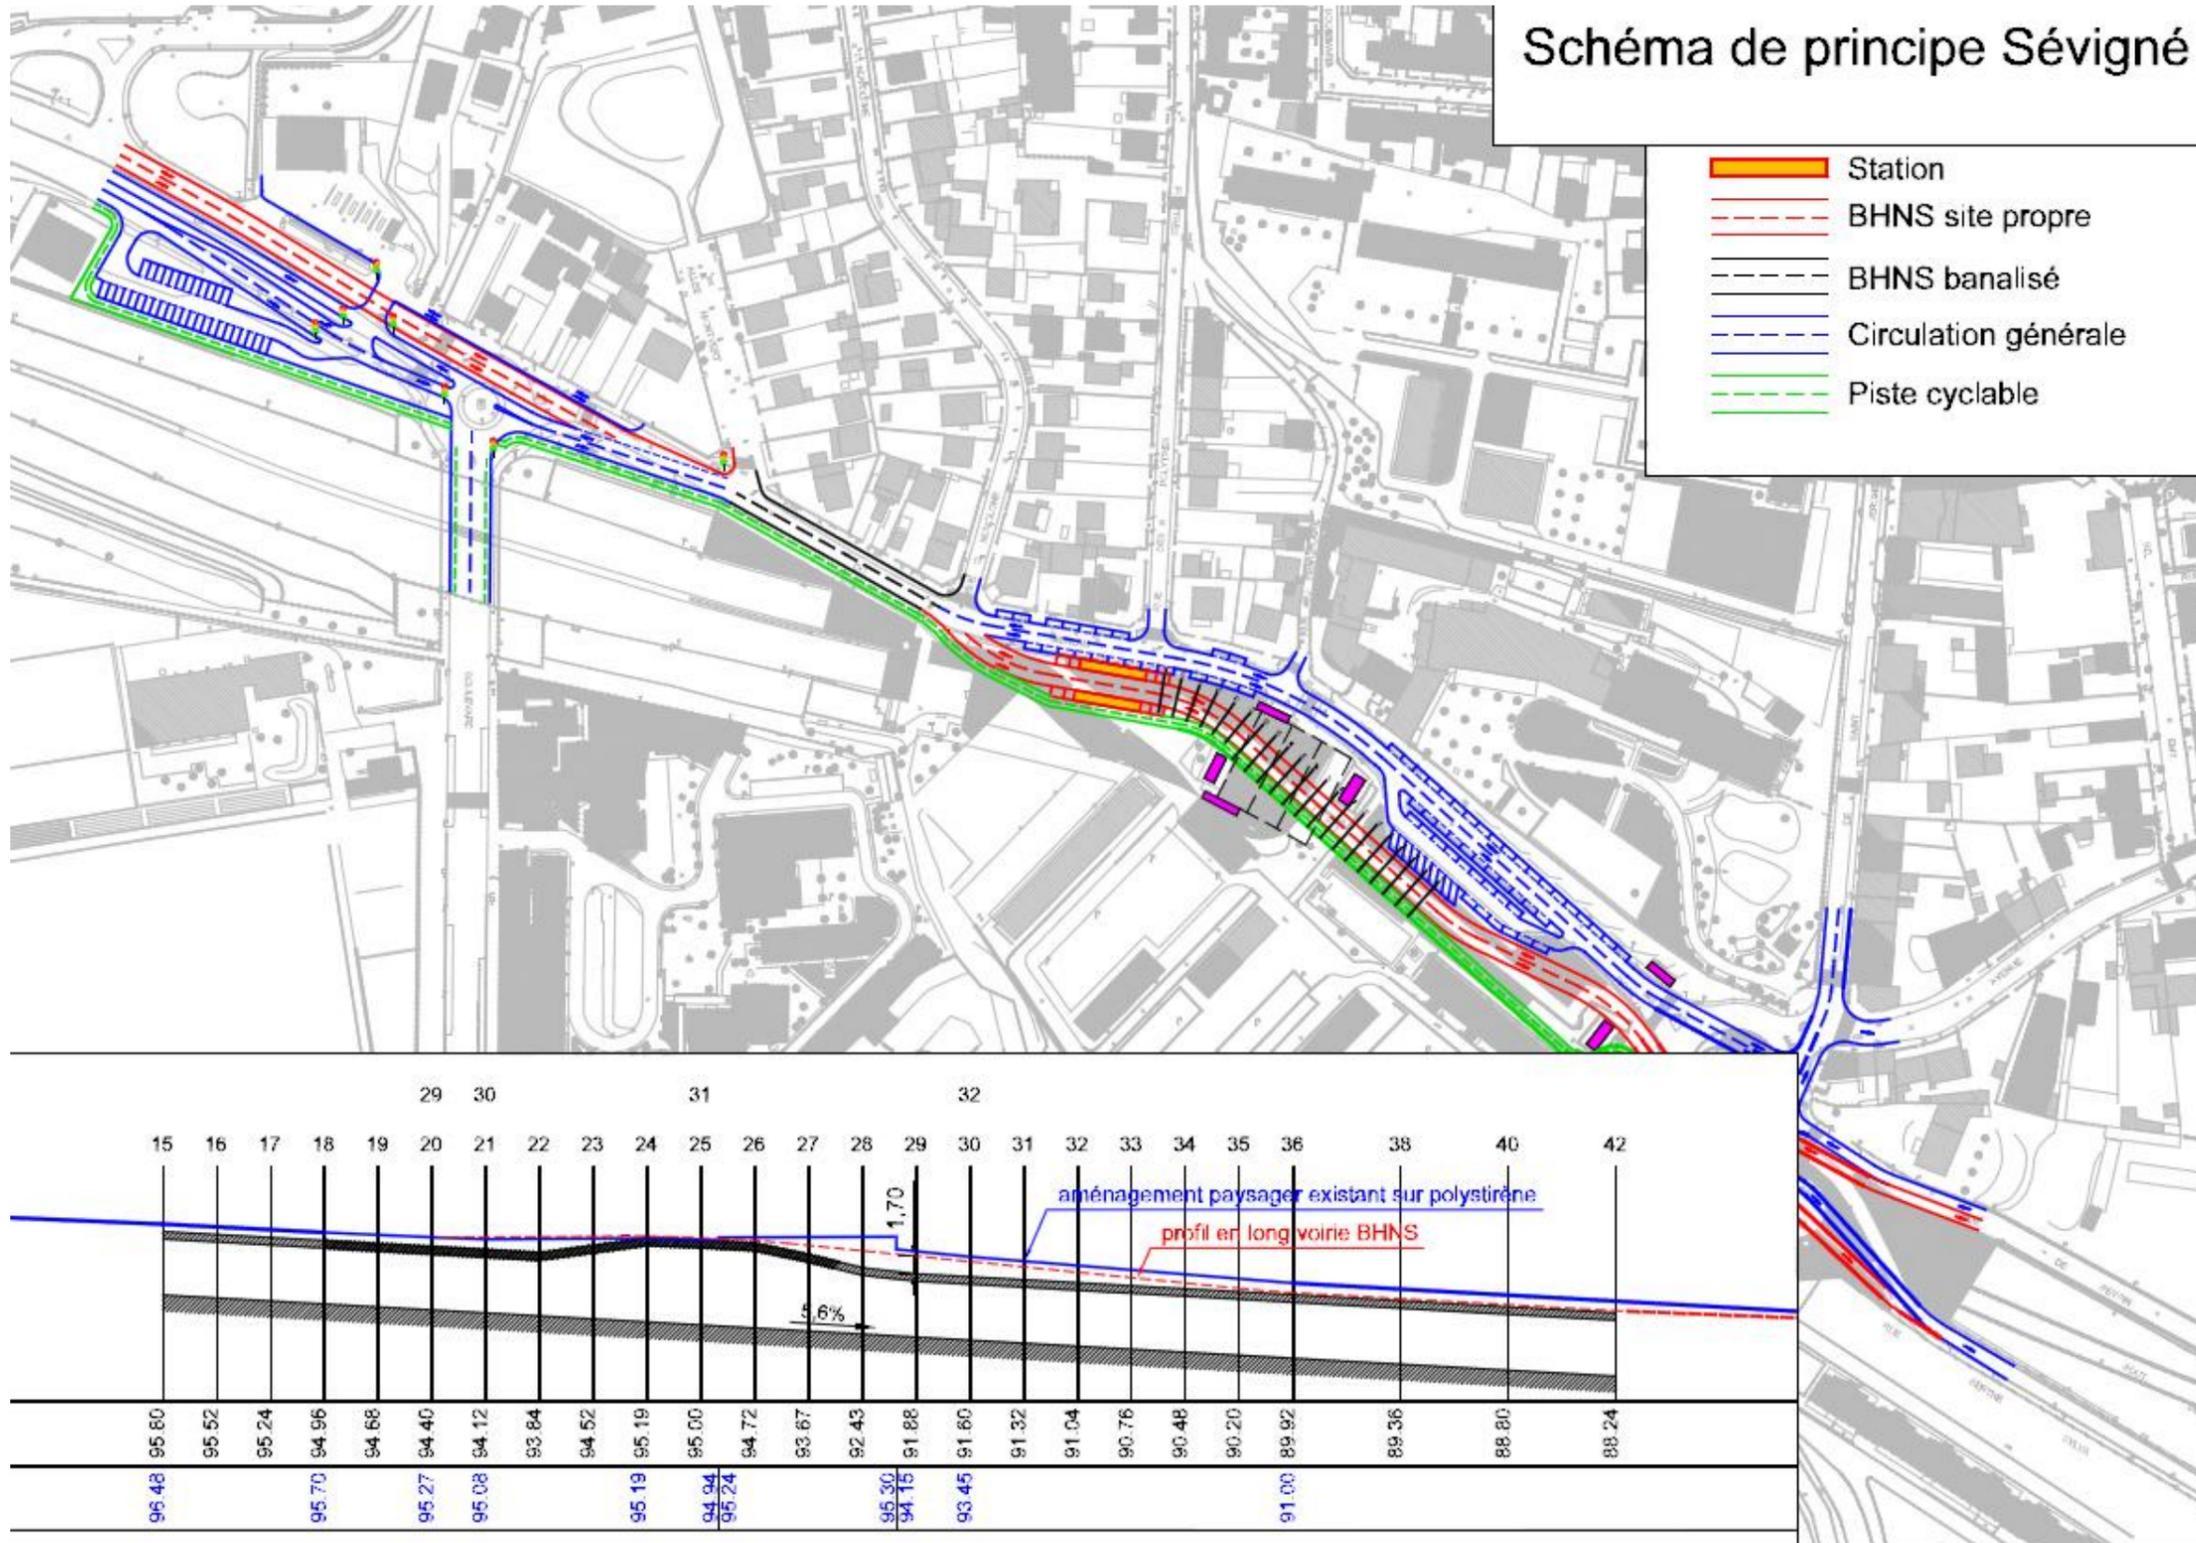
Sous variante 4 – Passage du BHNS en site propre sur la dalle des Tilleuls (Source : Etudes d'avant-projet)
